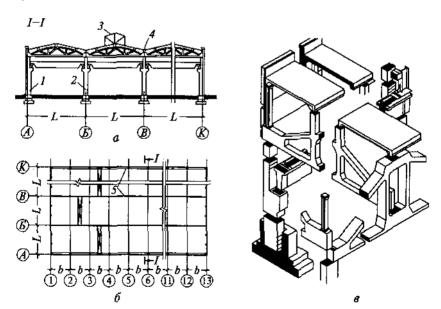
Конструктивно-технологическая схема одноэтажного промздания с железобетонным каркасом:
